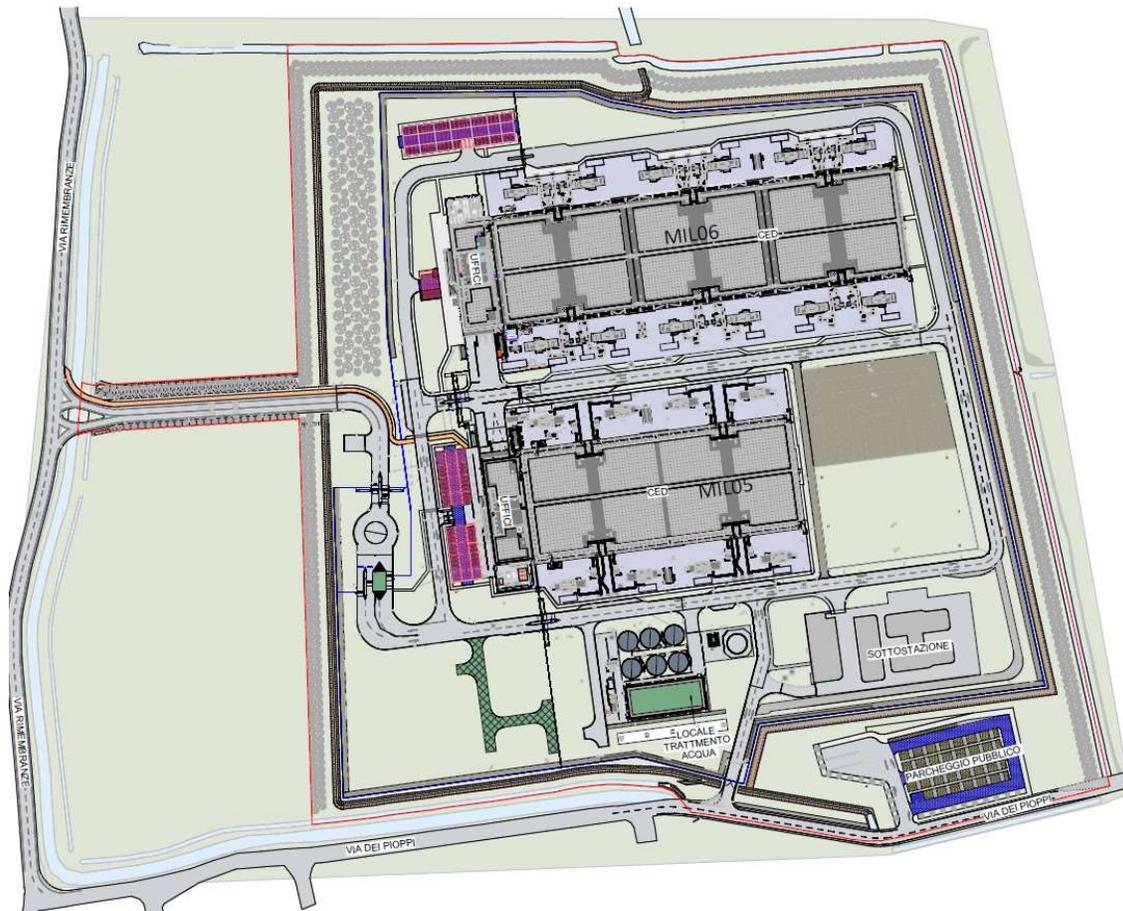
Stralcio Planimetria generale di MIL05 e MIL06 all'interno del sito
